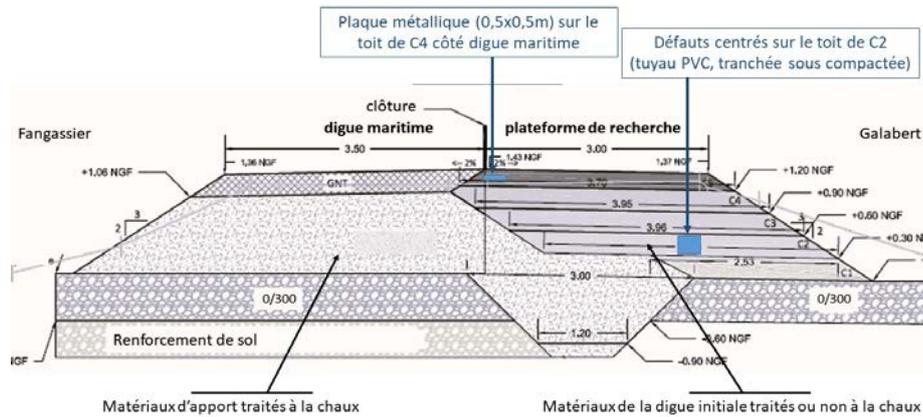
Coupe en travers de la digue et disposition des défauts contrôlés.
